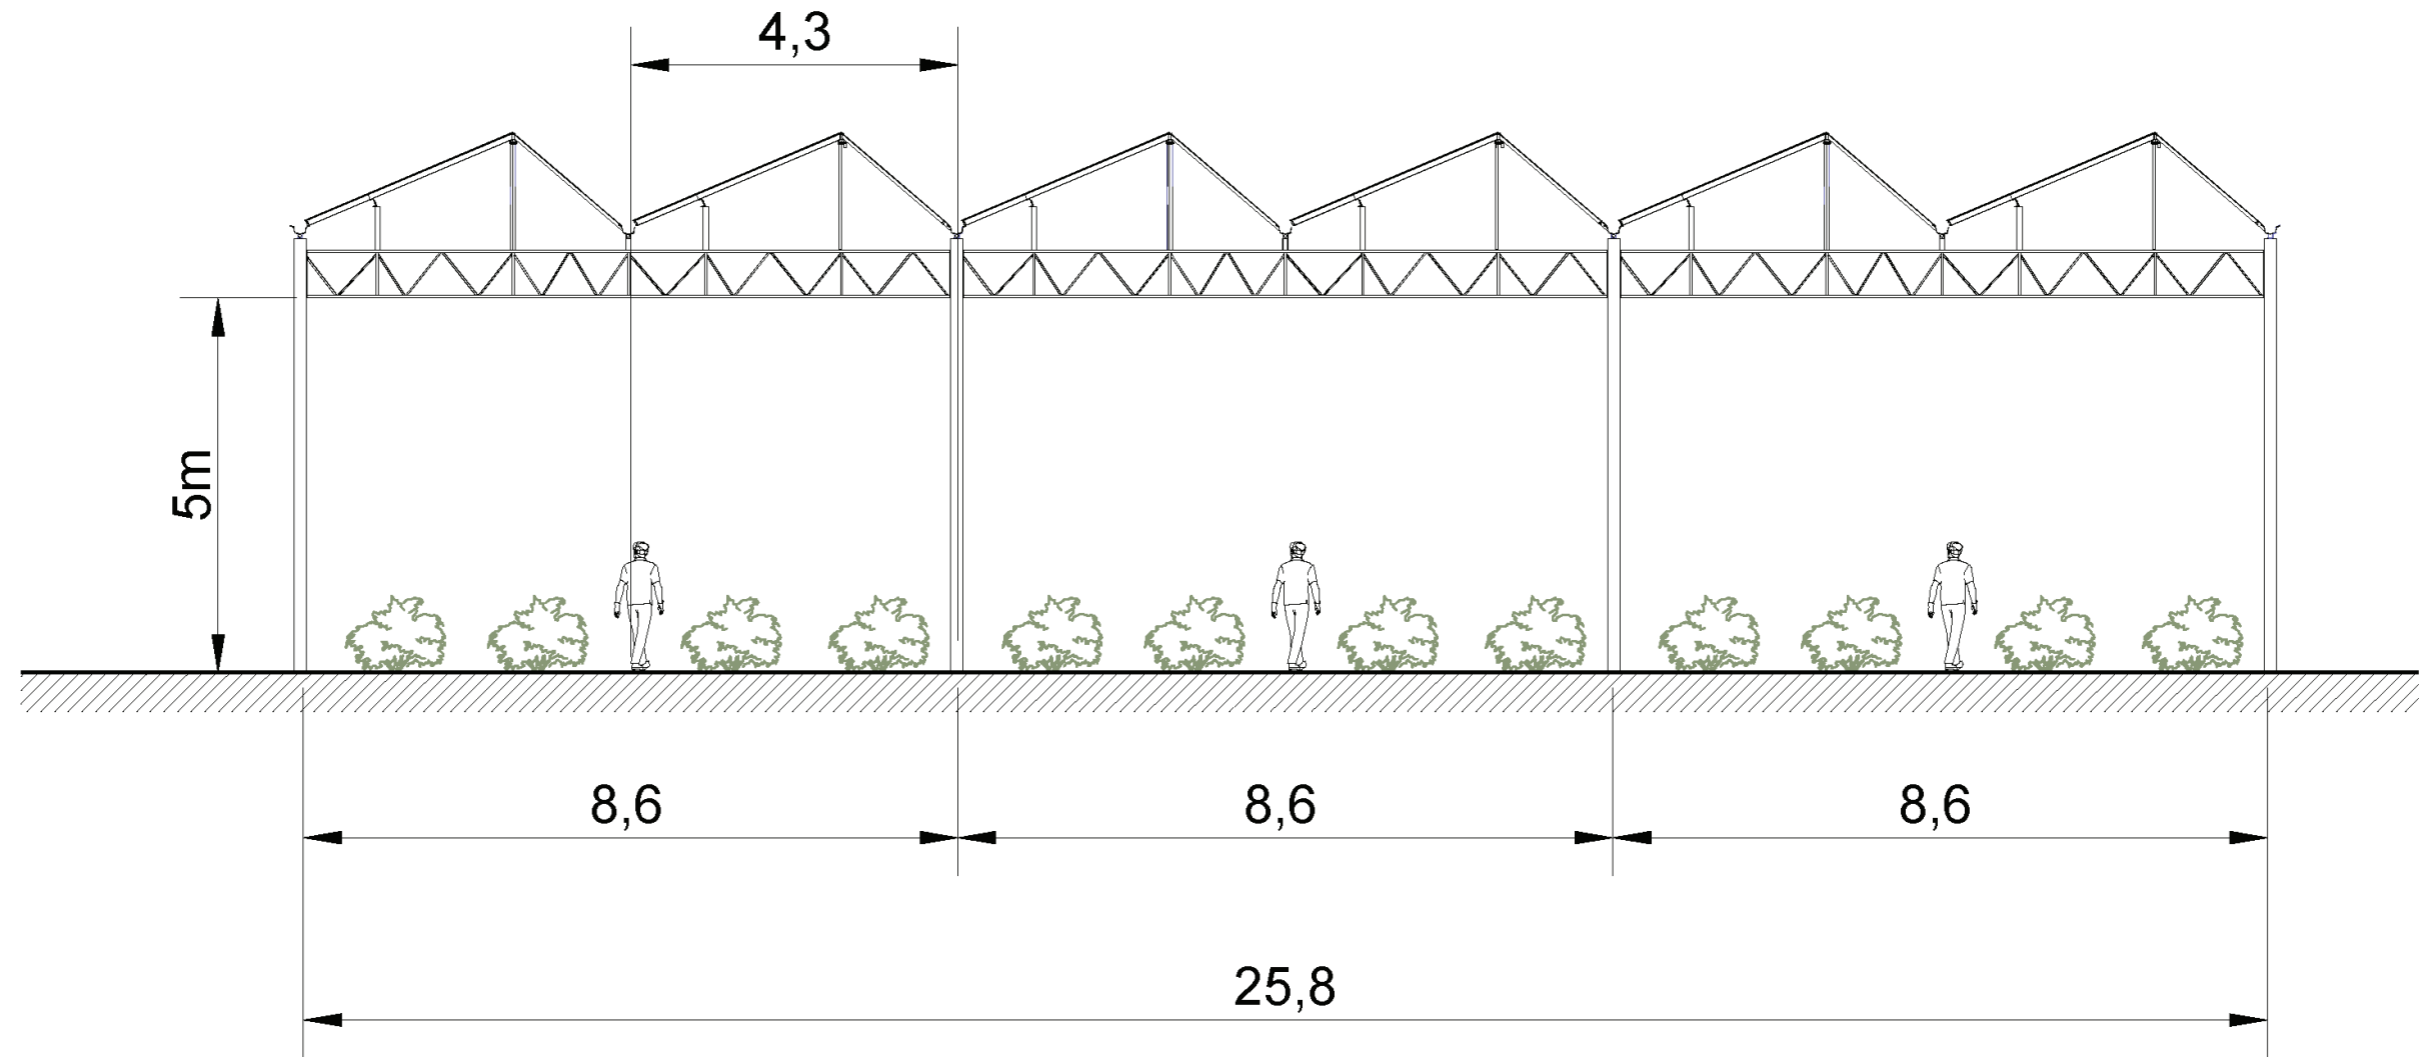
Plan d'implantation (Source : AMARENCO, Avril 2022)
